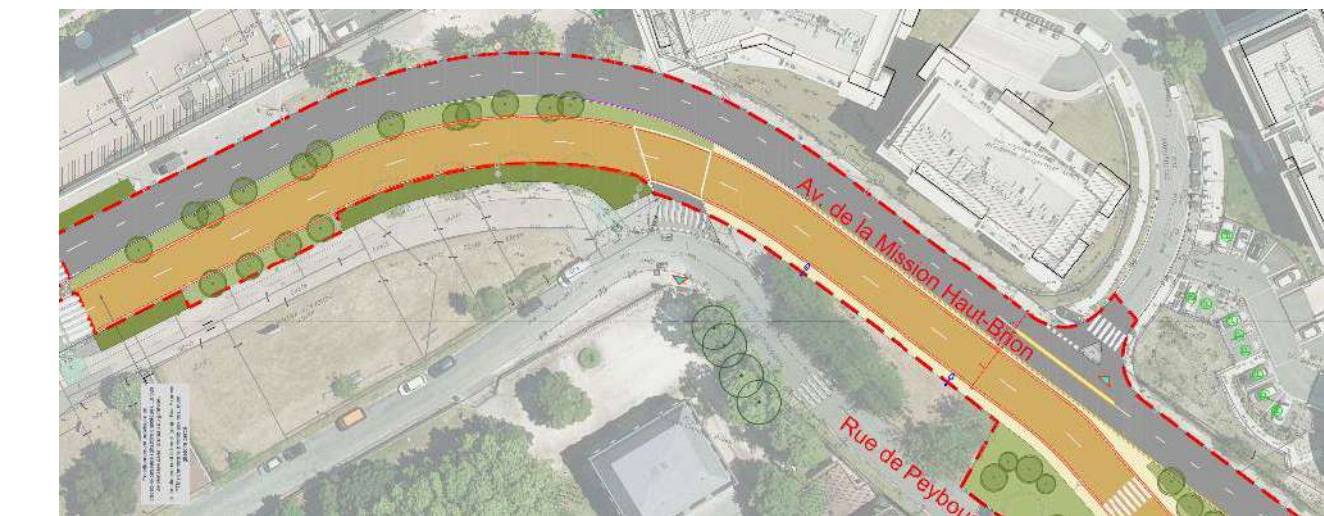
Plan AVP de l'avenue de la Mission Haut Brion
